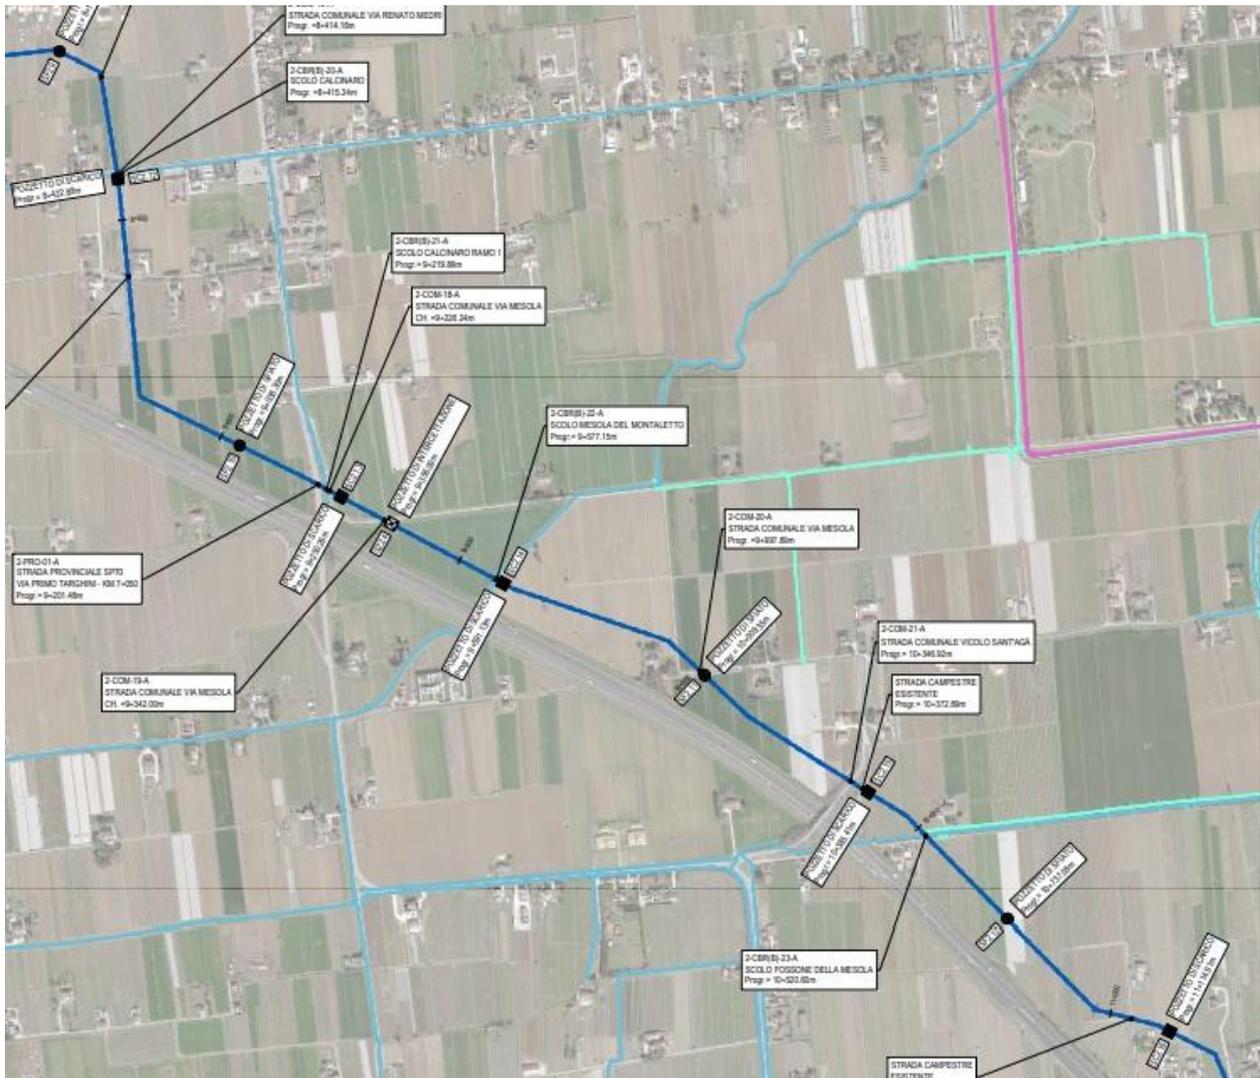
la sezione centrale del Lotto 2 ad Est del F. Savio: è evidente la regolarità del reticolo stradale
